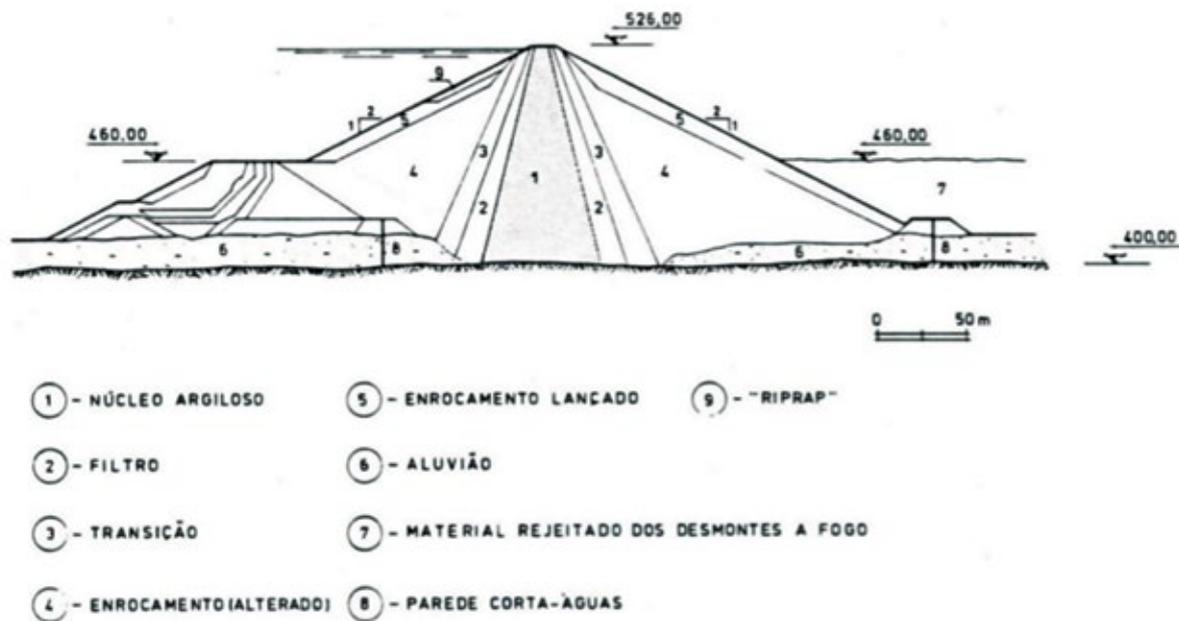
Seção típica de uma barragem de terra – enrocamento.
